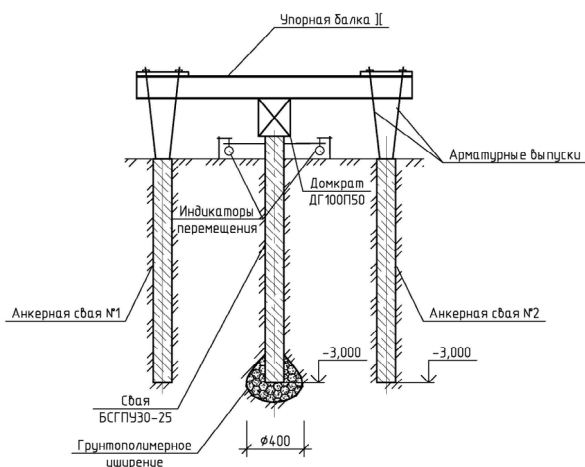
Схема испытания сваи вертикальной статической вдавливающей нагрузкой
